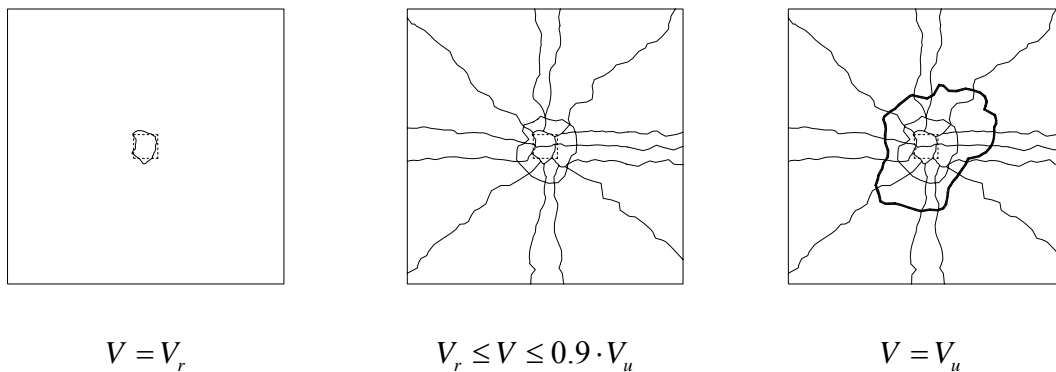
Evolution des fissures sur la face tendue d'une dalle pendant la mise en charge
